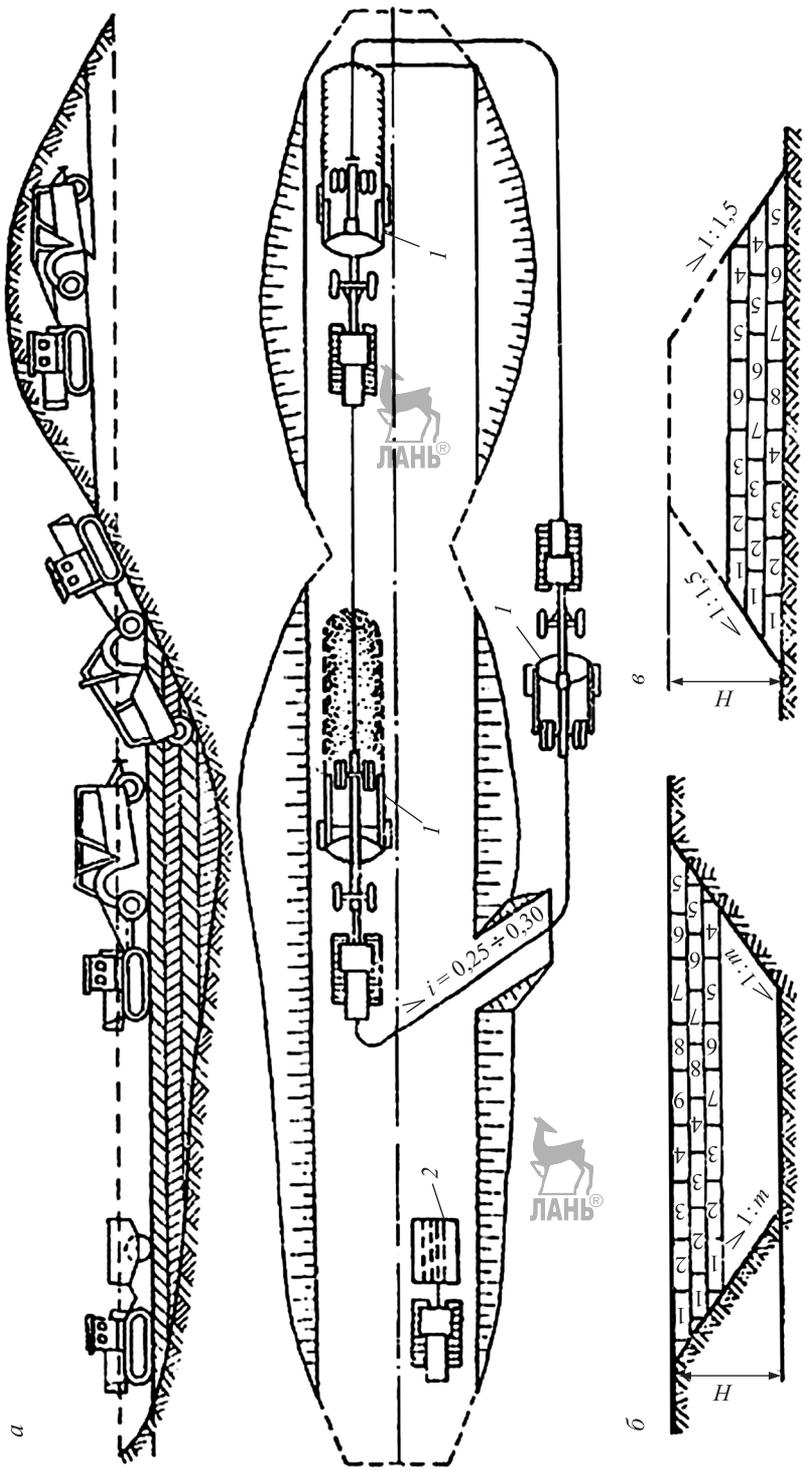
Технологическая схема отсыпки насыпи земляного полотна из грунта выемки:
